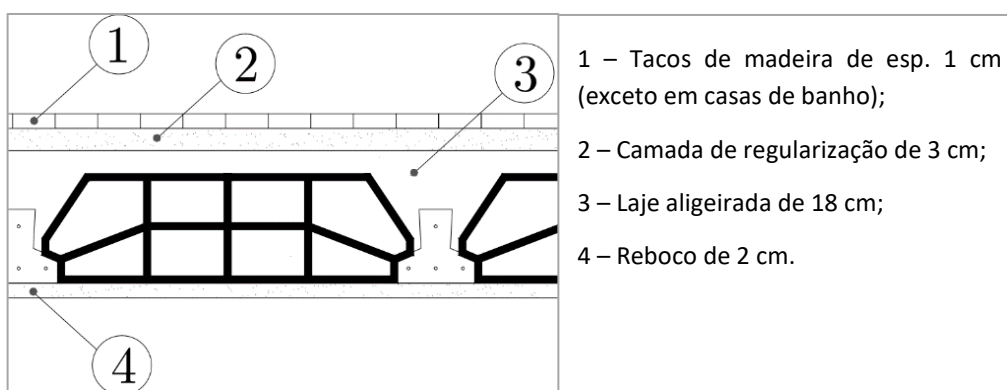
Estrutura do pavimento da parte ampliada.
